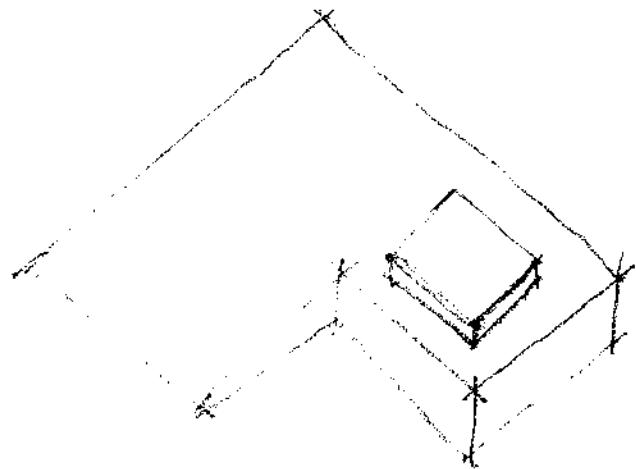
Primera imagen del proyecto. Elaboración propia.
